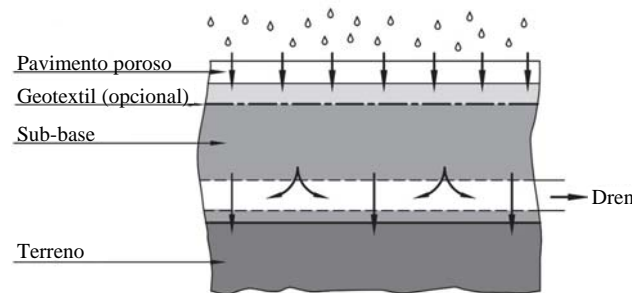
Sección tipo de un pavimento poroso combinado (adaptado de Woods-Ballard et al., 2007).
